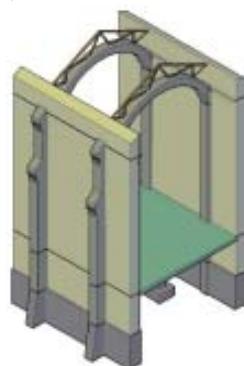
Recrecio de los muros y celosía. *Built-up walls and trusses.* Fig. 8. Celosía metálica. *Steel truss.
